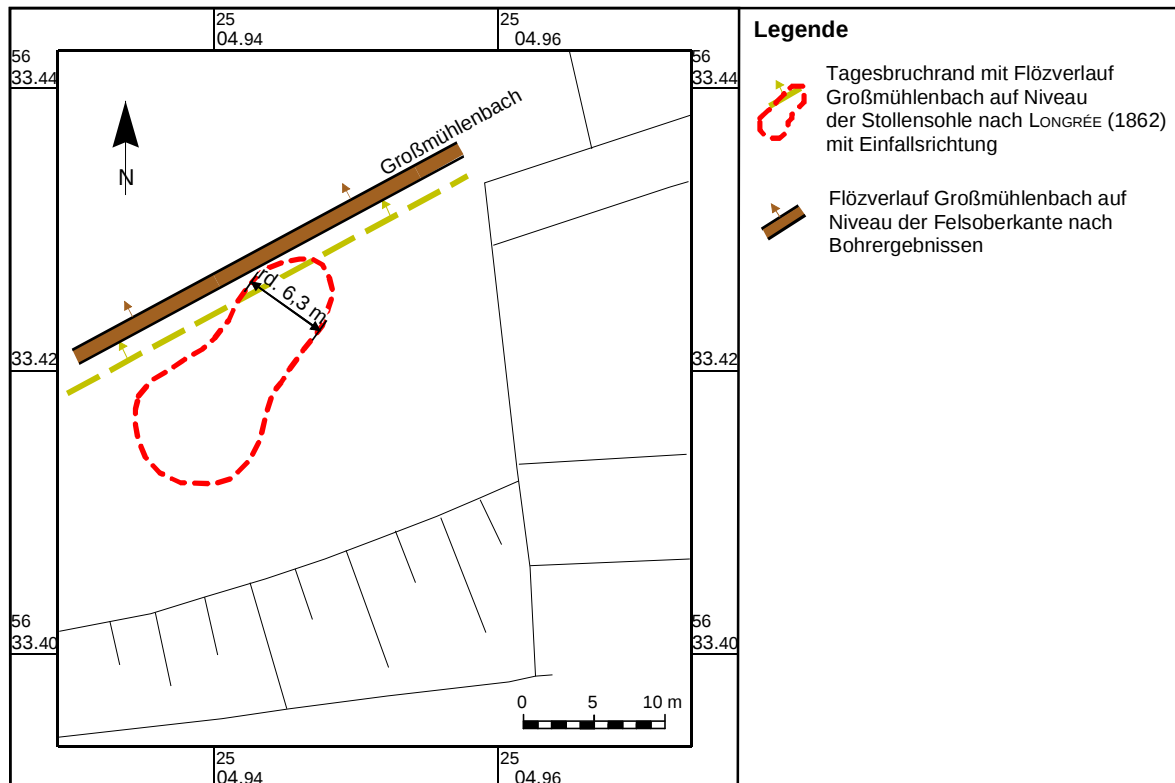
Lageplan Tagesbruch im Bereich der Haus-Heyden-Straße, Herzogenrath
